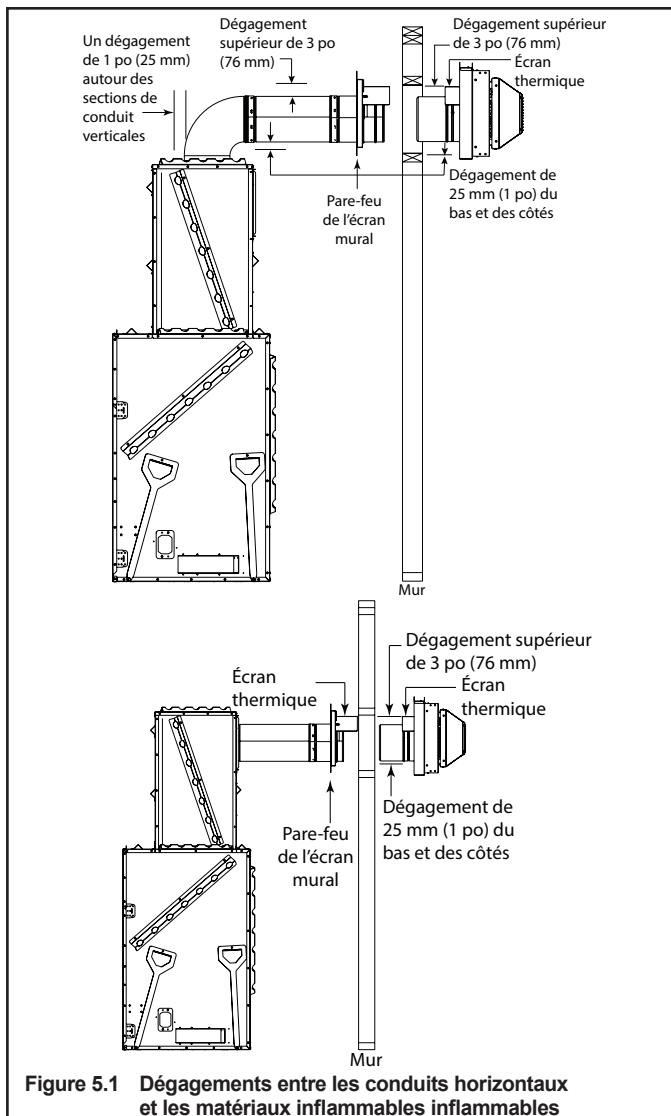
Dégagements entre les conduits horizontaux et les matériaux inflammables
